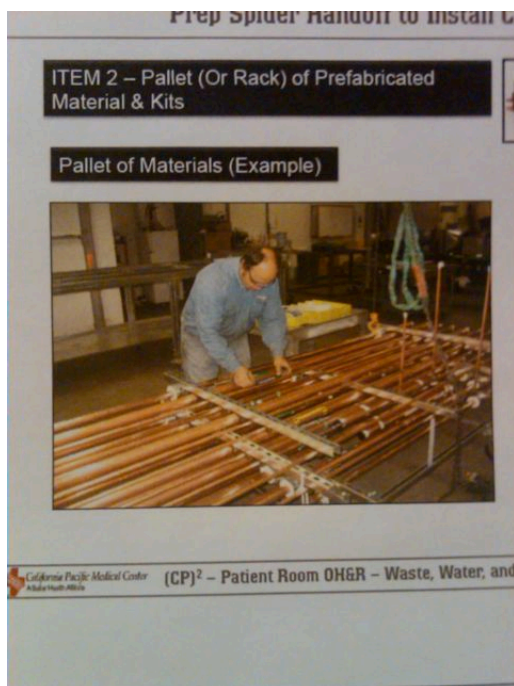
Prefabricación y suministro en Palets para facilitar en montaje en obra.
